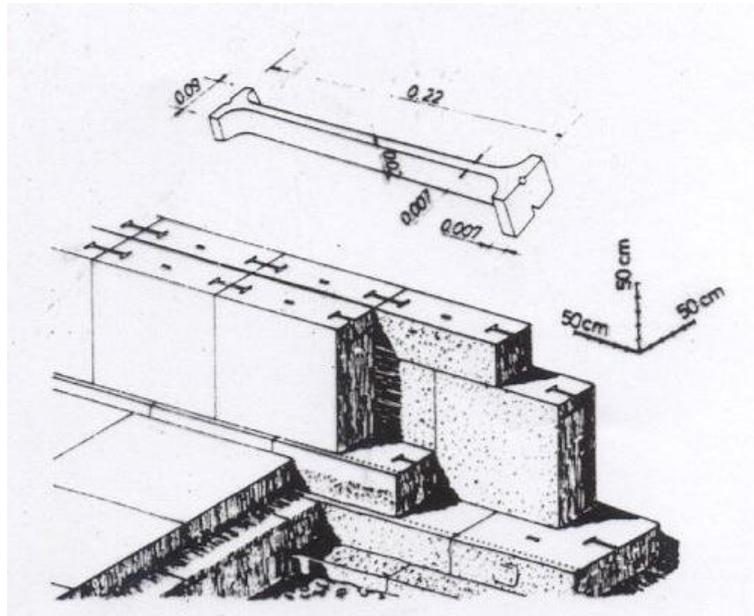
Cimientos de sillería con llaves metálicas en templos griegos. Marín Sánchez, R. (2000) "La Construcción Griega y Romana".
